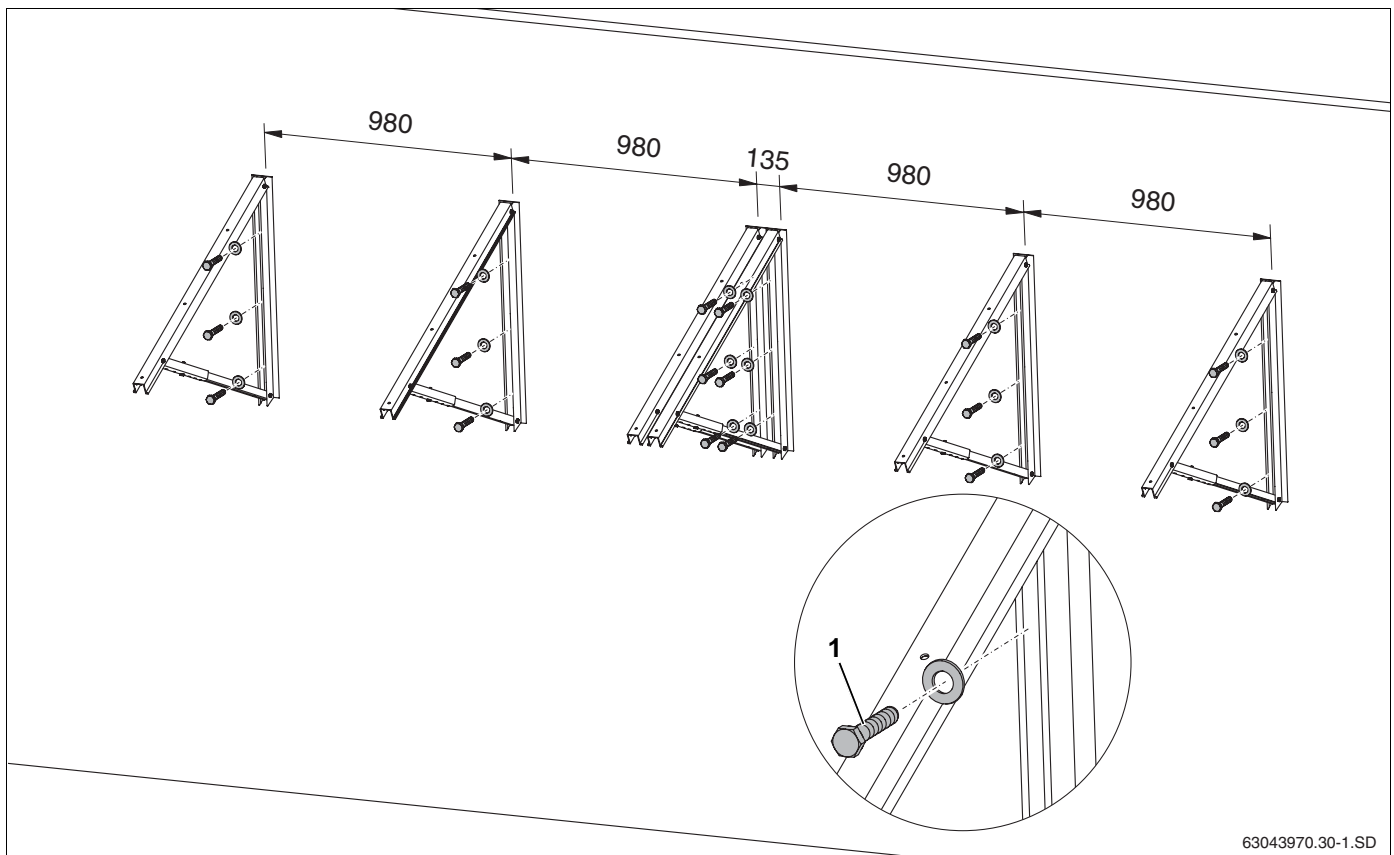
Montering av solpanelshållarna på fasaden för 2 solpaneler (mått i mm)
